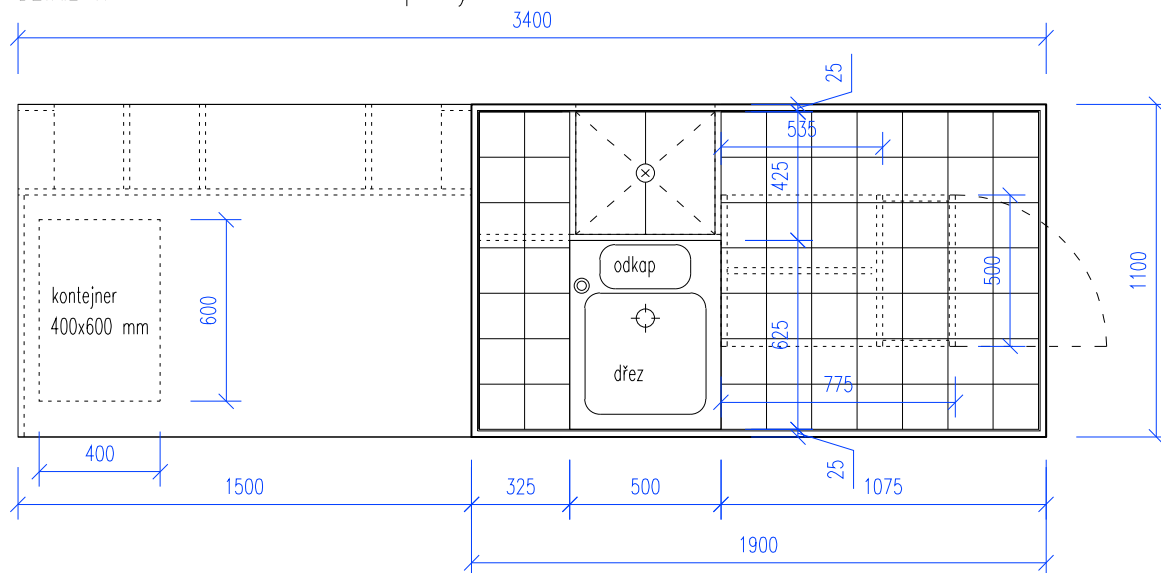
LABORATORNÍ STŮL - STUDENTI - půdorys
